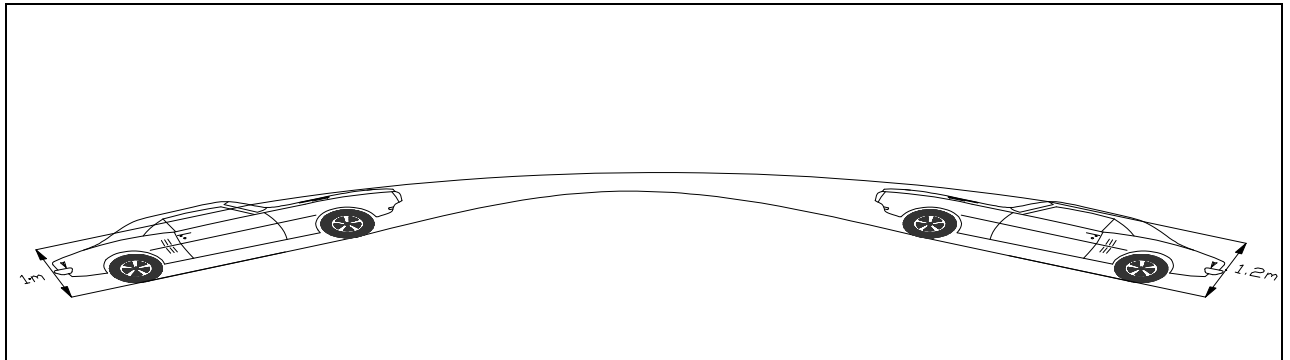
visibilité sur chaussée bidirectionnelle. [2]
